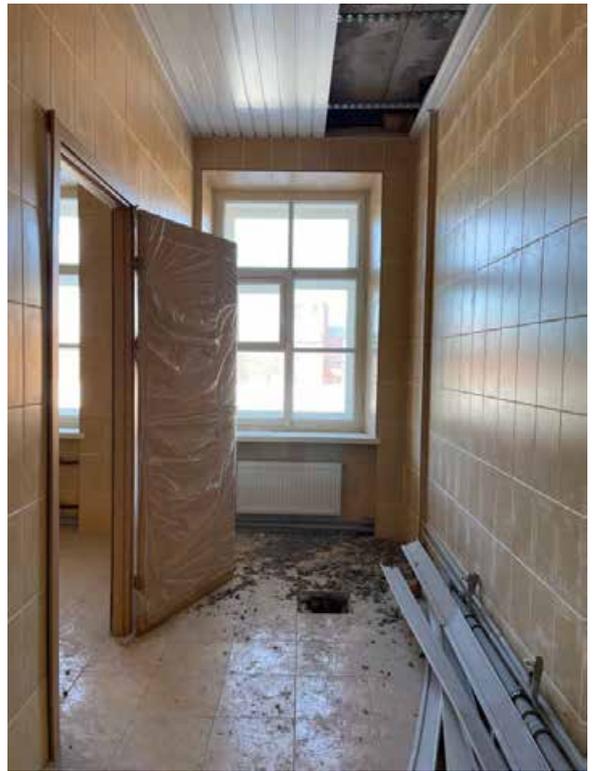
, 3.2. 3 этаж. Лестница в южной части здания. Помещение южнее лестницы.
